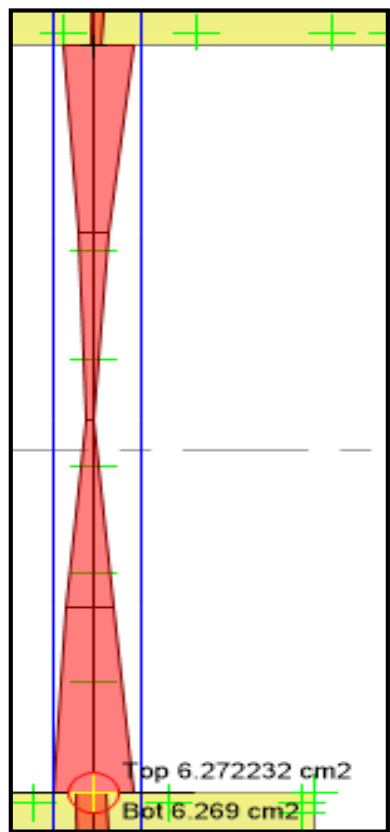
Detalle del acero en la viga de cimentación- Tramo de ejes B a eje A.
